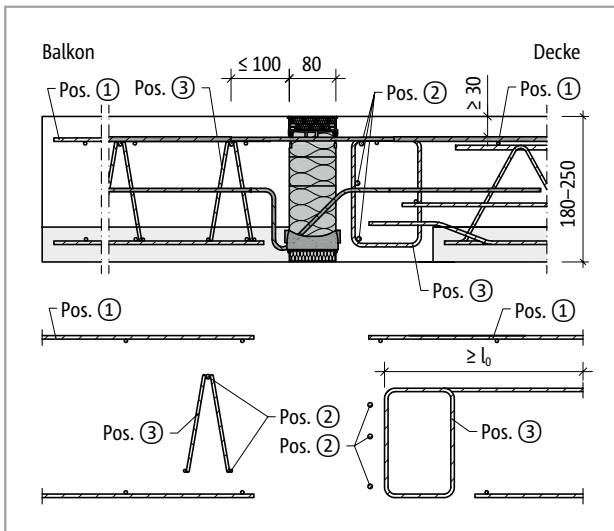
Schöck Isokorb® T Typ K-F: Bauseitige Bewehrung bei Balkonplattendicke $h = 180\text{--}250\text{ mm}$ mit Gitterträger (Pos.2: $5\phi 8$)
